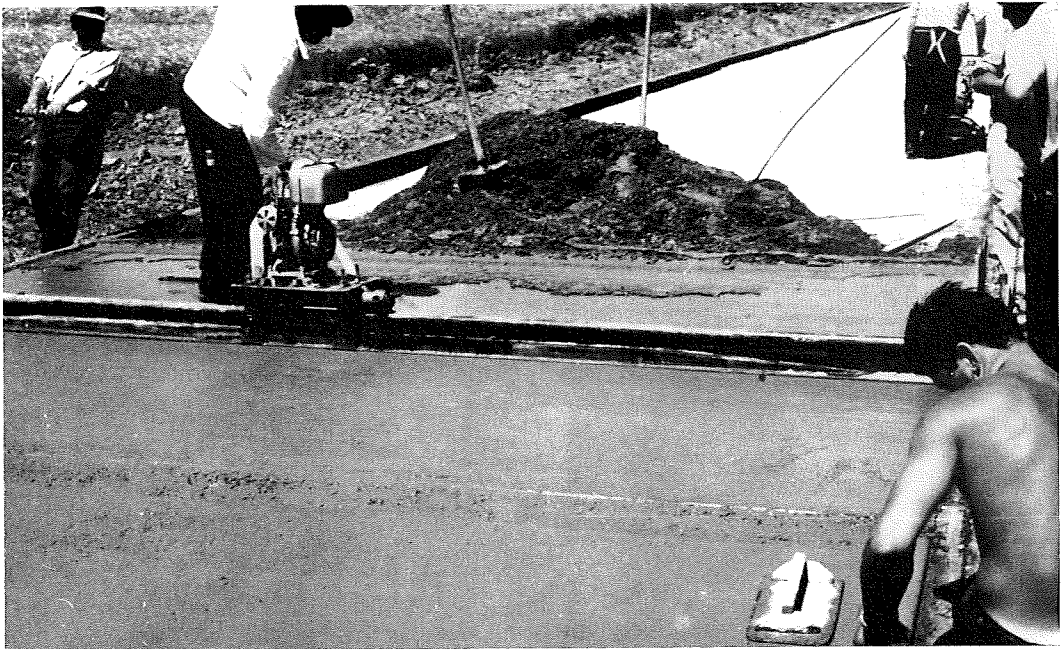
Befestigen der Fugenbretter (Burghard)
